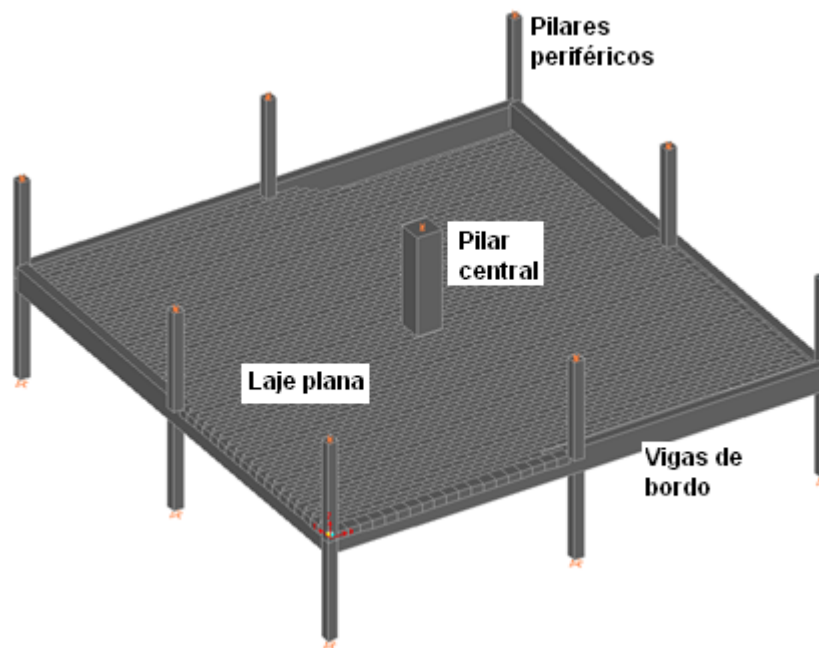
Vista 3D do modelo com as dimensões dos elementos
